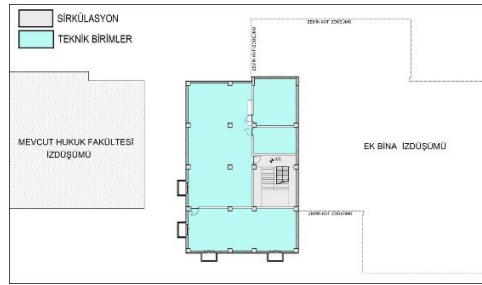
Zemin Kat Planı Sirkülasyon Bağlantısı [32]
